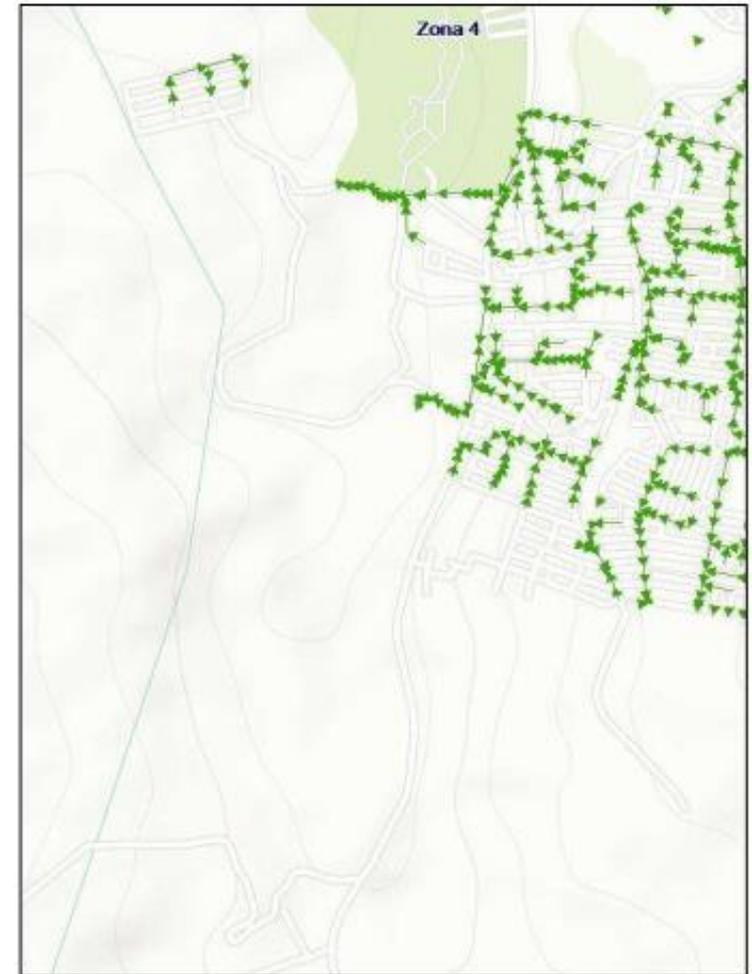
Sector hidráulico-redes de alcantarillado pluvial.
